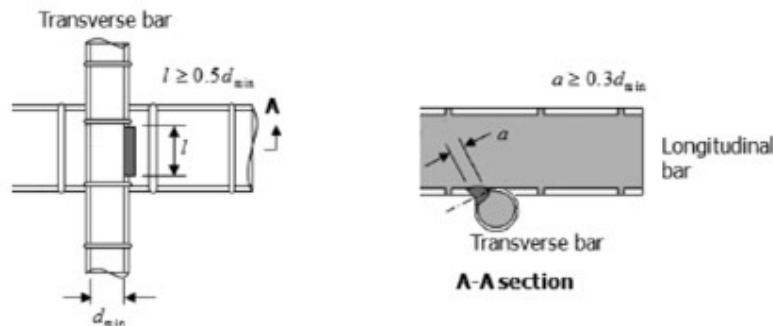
Dimensiones punto de soldadura (modificada referencia [23])
